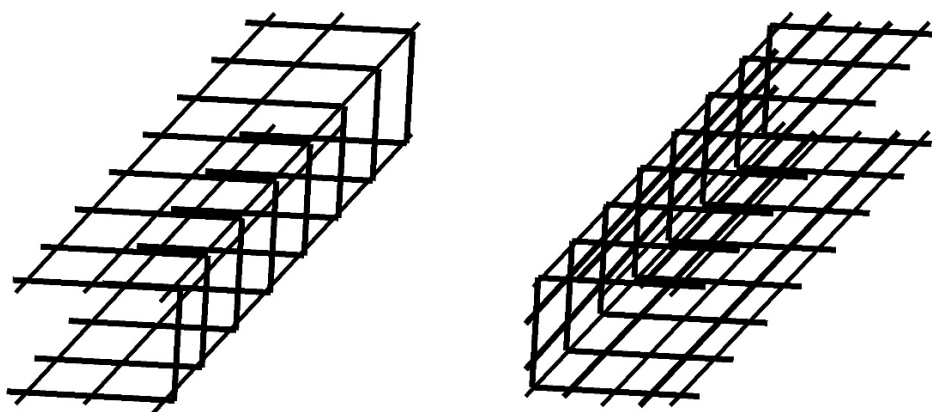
Zwei Bügelmattenarten mit unterschiedlichen statischen Anforderungen
